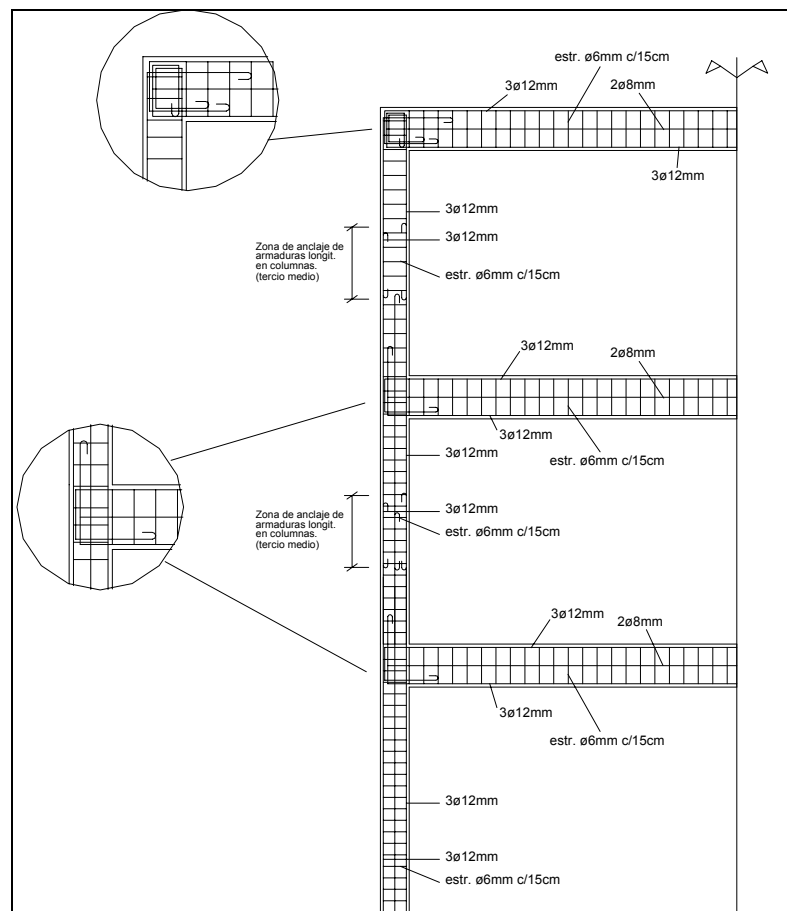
Esquema de disposiciones de armaduras en vigas y columnas.
